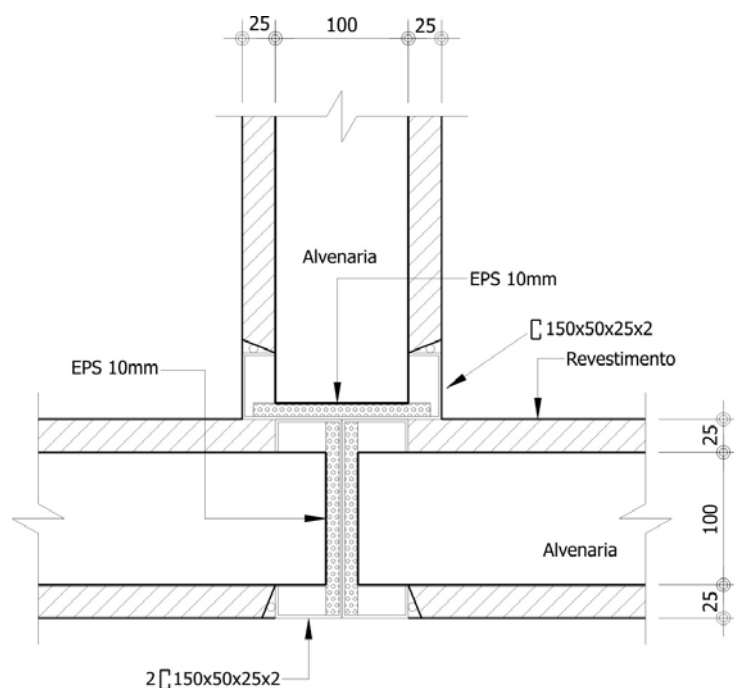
Detalhe de ligação entre duas paredes de extremidade.
